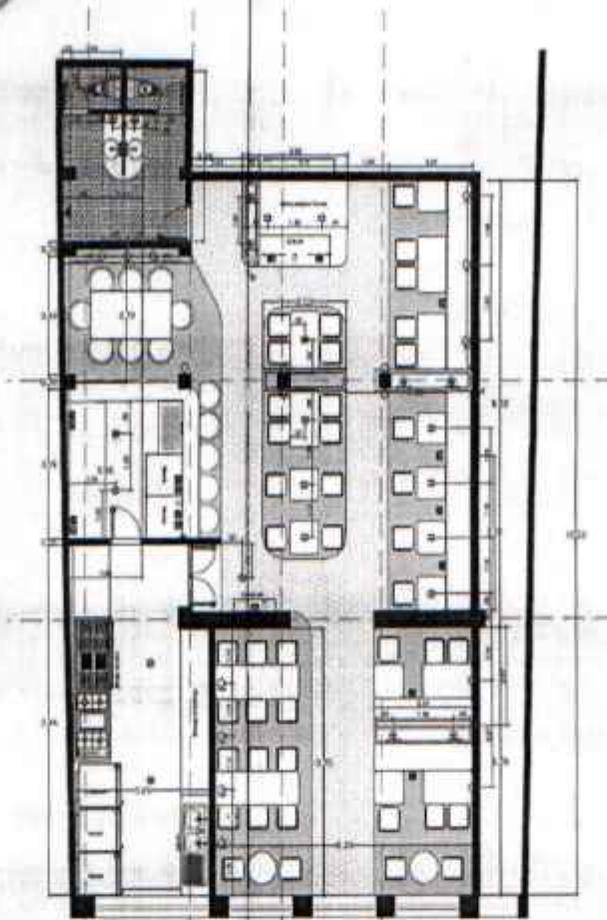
Plano RESTAURANTE SOBERANO -Área privada
